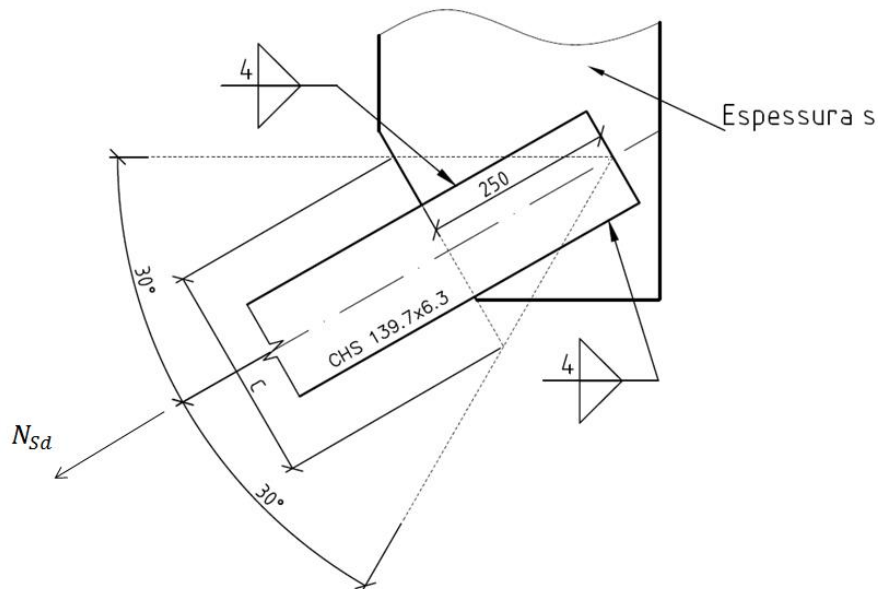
Ligação articulada – Cálculo da espessura da chapa de gousset
